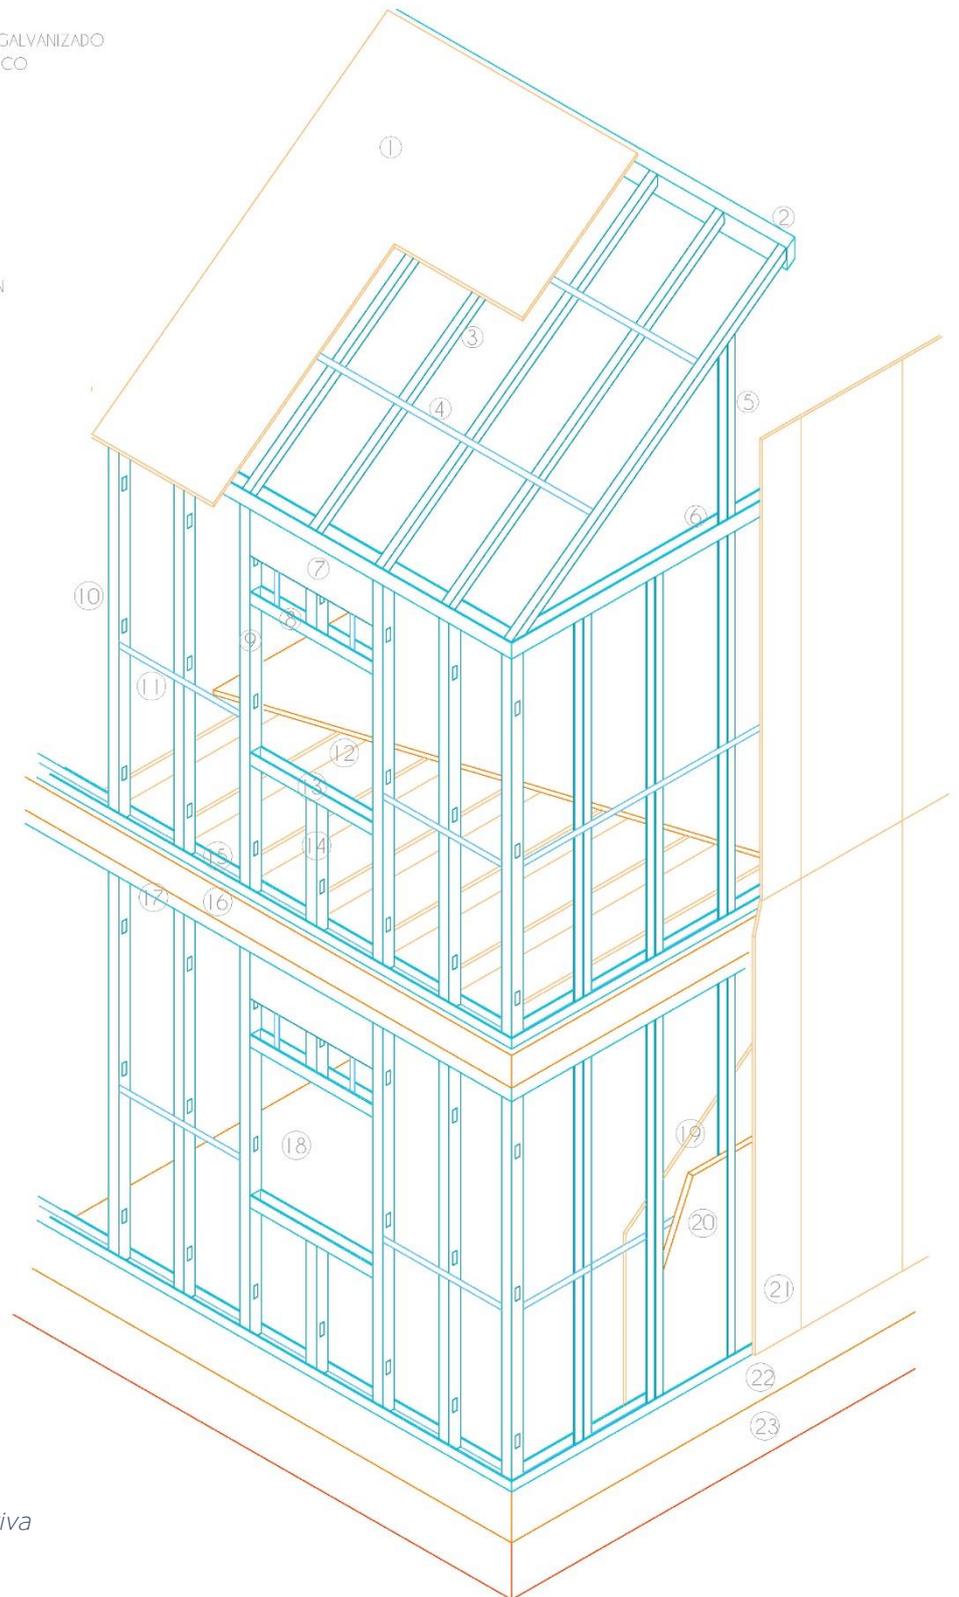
Axonometría constructiva Steel Frame (Dibujo original)
